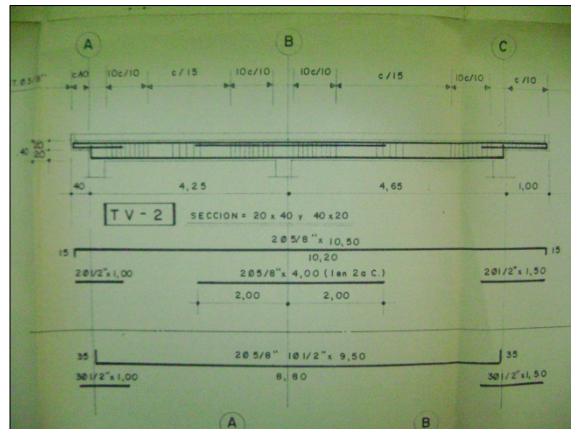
Fotografía de Plano de Estructura de Armado de Losas
